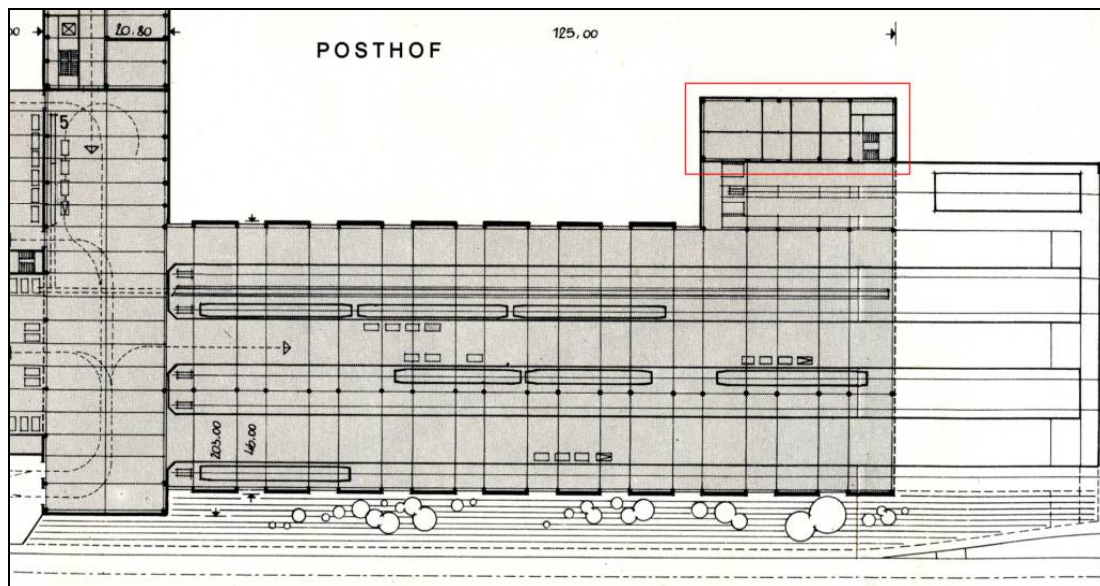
Ebene Postbahnhof mit Bahnpostdienstgebäude - Grundriß
